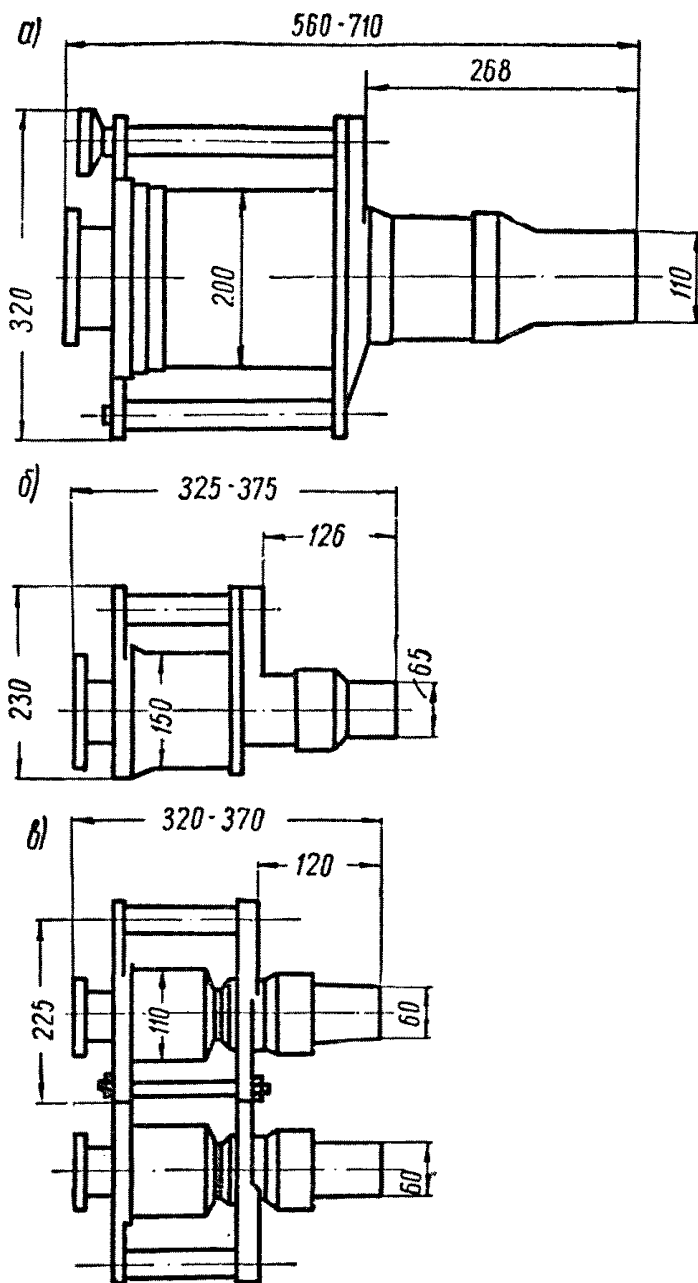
Габариты гидравлических домкратов для натяжения стержневой арматуры
